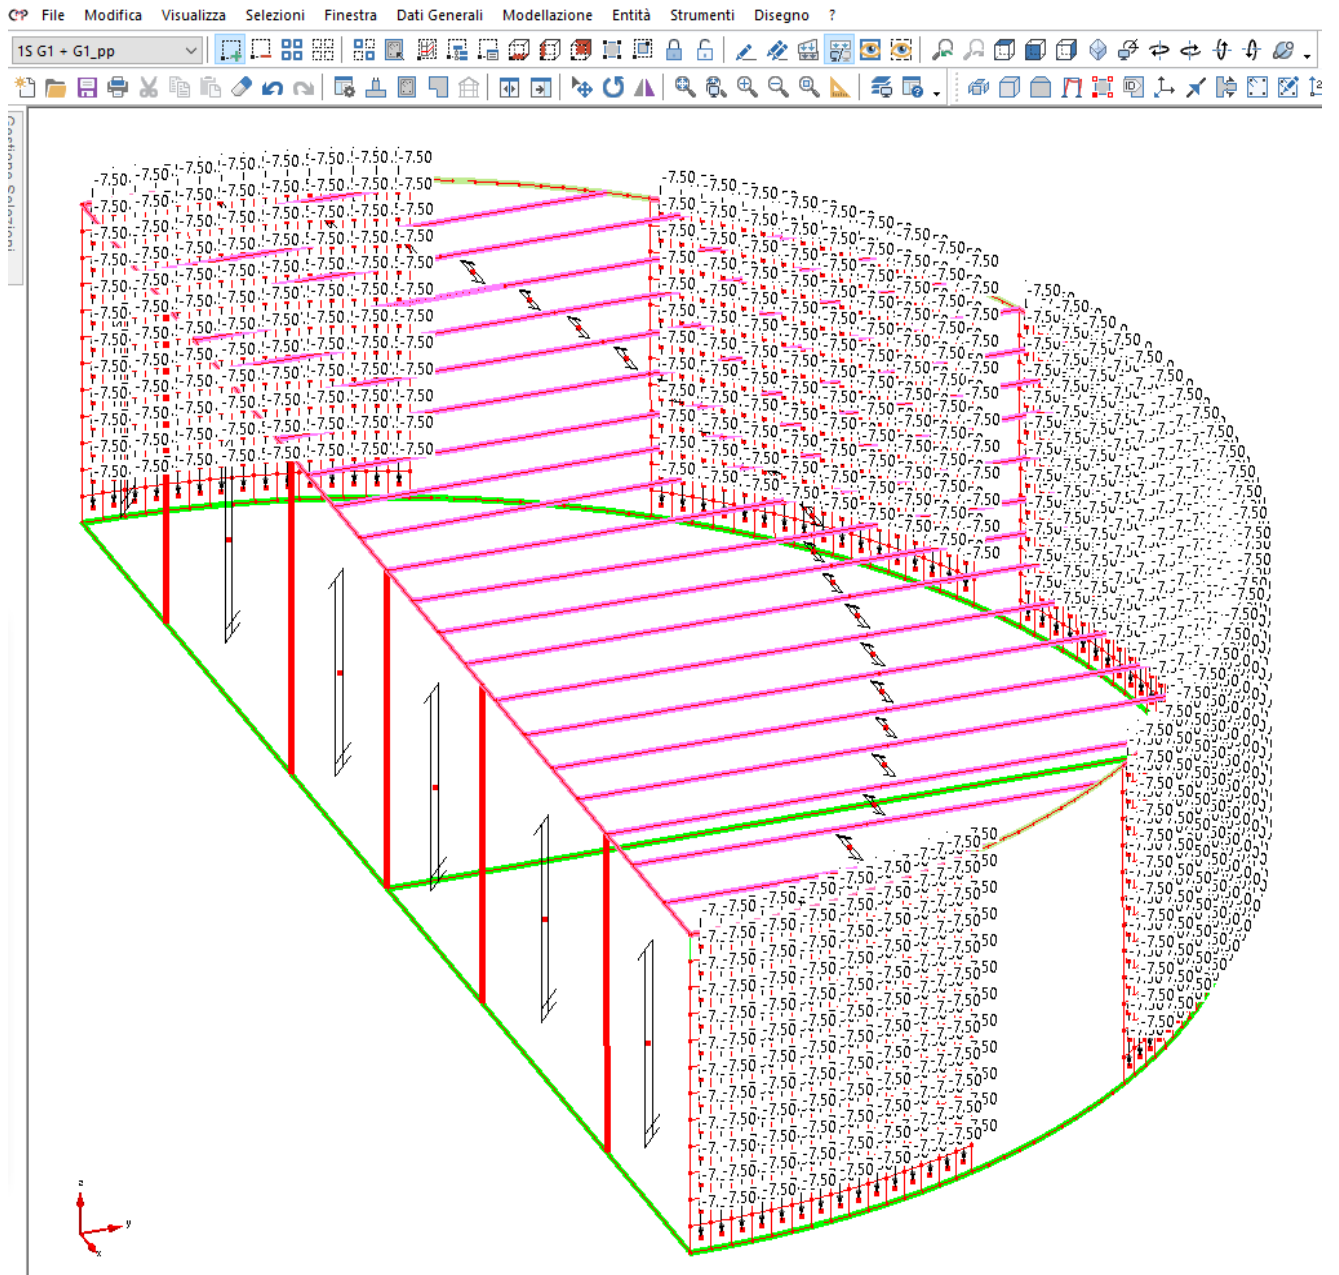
Carichi distribuiti per unità di superficie [kN/m] – G1_PP (Peso Proprio strutture in elevazione – Elementi Shell dettaglio).
